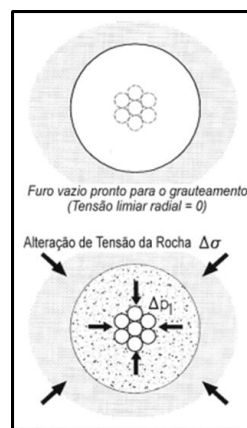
Alteração de tensão e pressão da interface (*Cablebolting in Underground Mine*, 1996).
